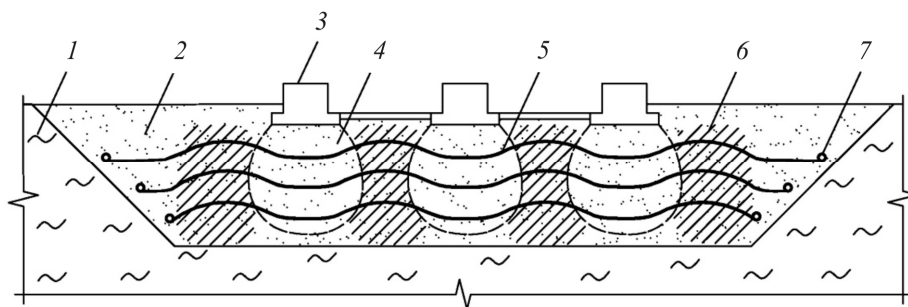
Фундаменты на песчаной подушке с включениями набухающего вещества: 1 – слабый грунт; 2 – песок; 3 – ленточный фундамент; 4 – область действия вертикальных сжимающих напряжений; 5 – армирующий материал; 6 – песчаный грунт с добавлением увеличивающегося в объеме материала; 7 – анкерующий элемент
